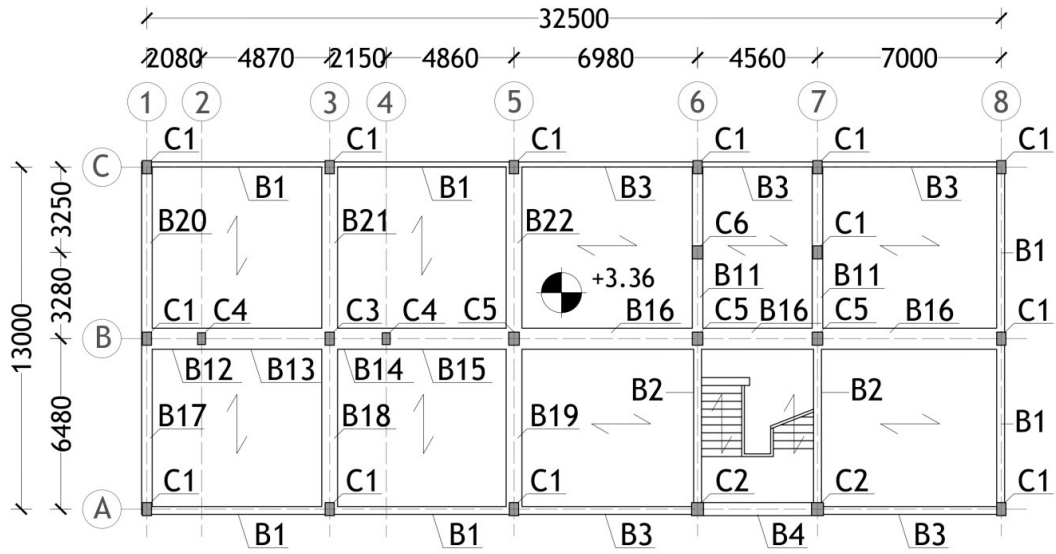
Pianta strutturale del primo impalcato a quota +3.36 m
